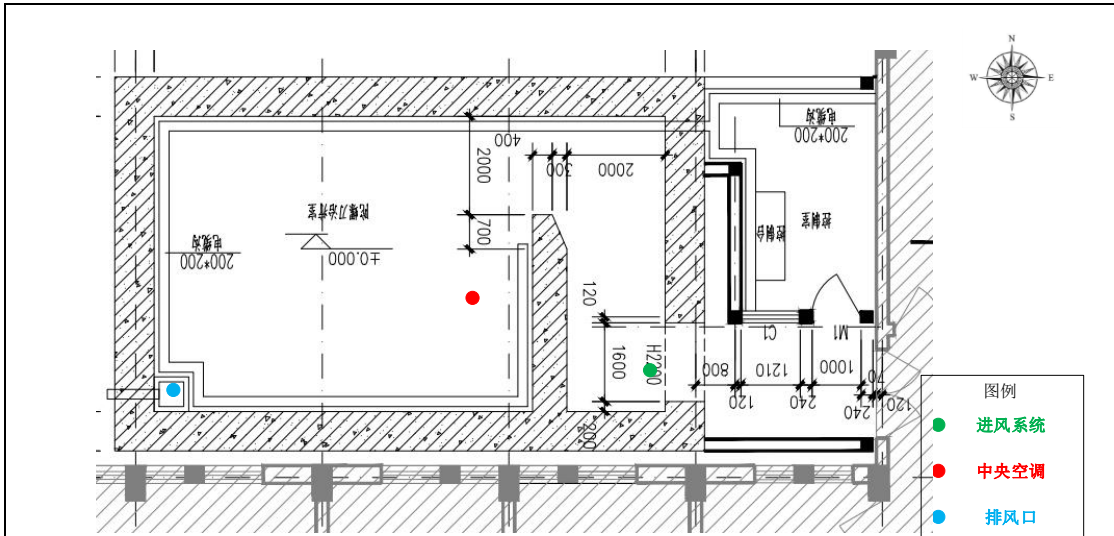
本项目陀螺刀机房的通风设施平面布局示意图
